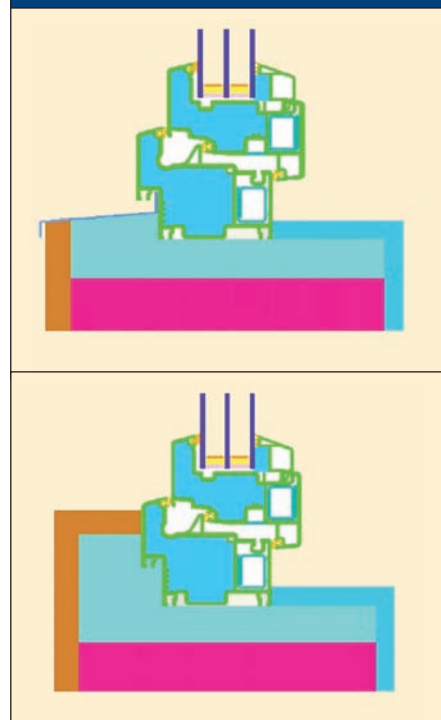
Vergleich wärmetechnischer Daten zum Fenstereinbau im Altbau ohne bzw. mit Wärmedämmverbundsystem
